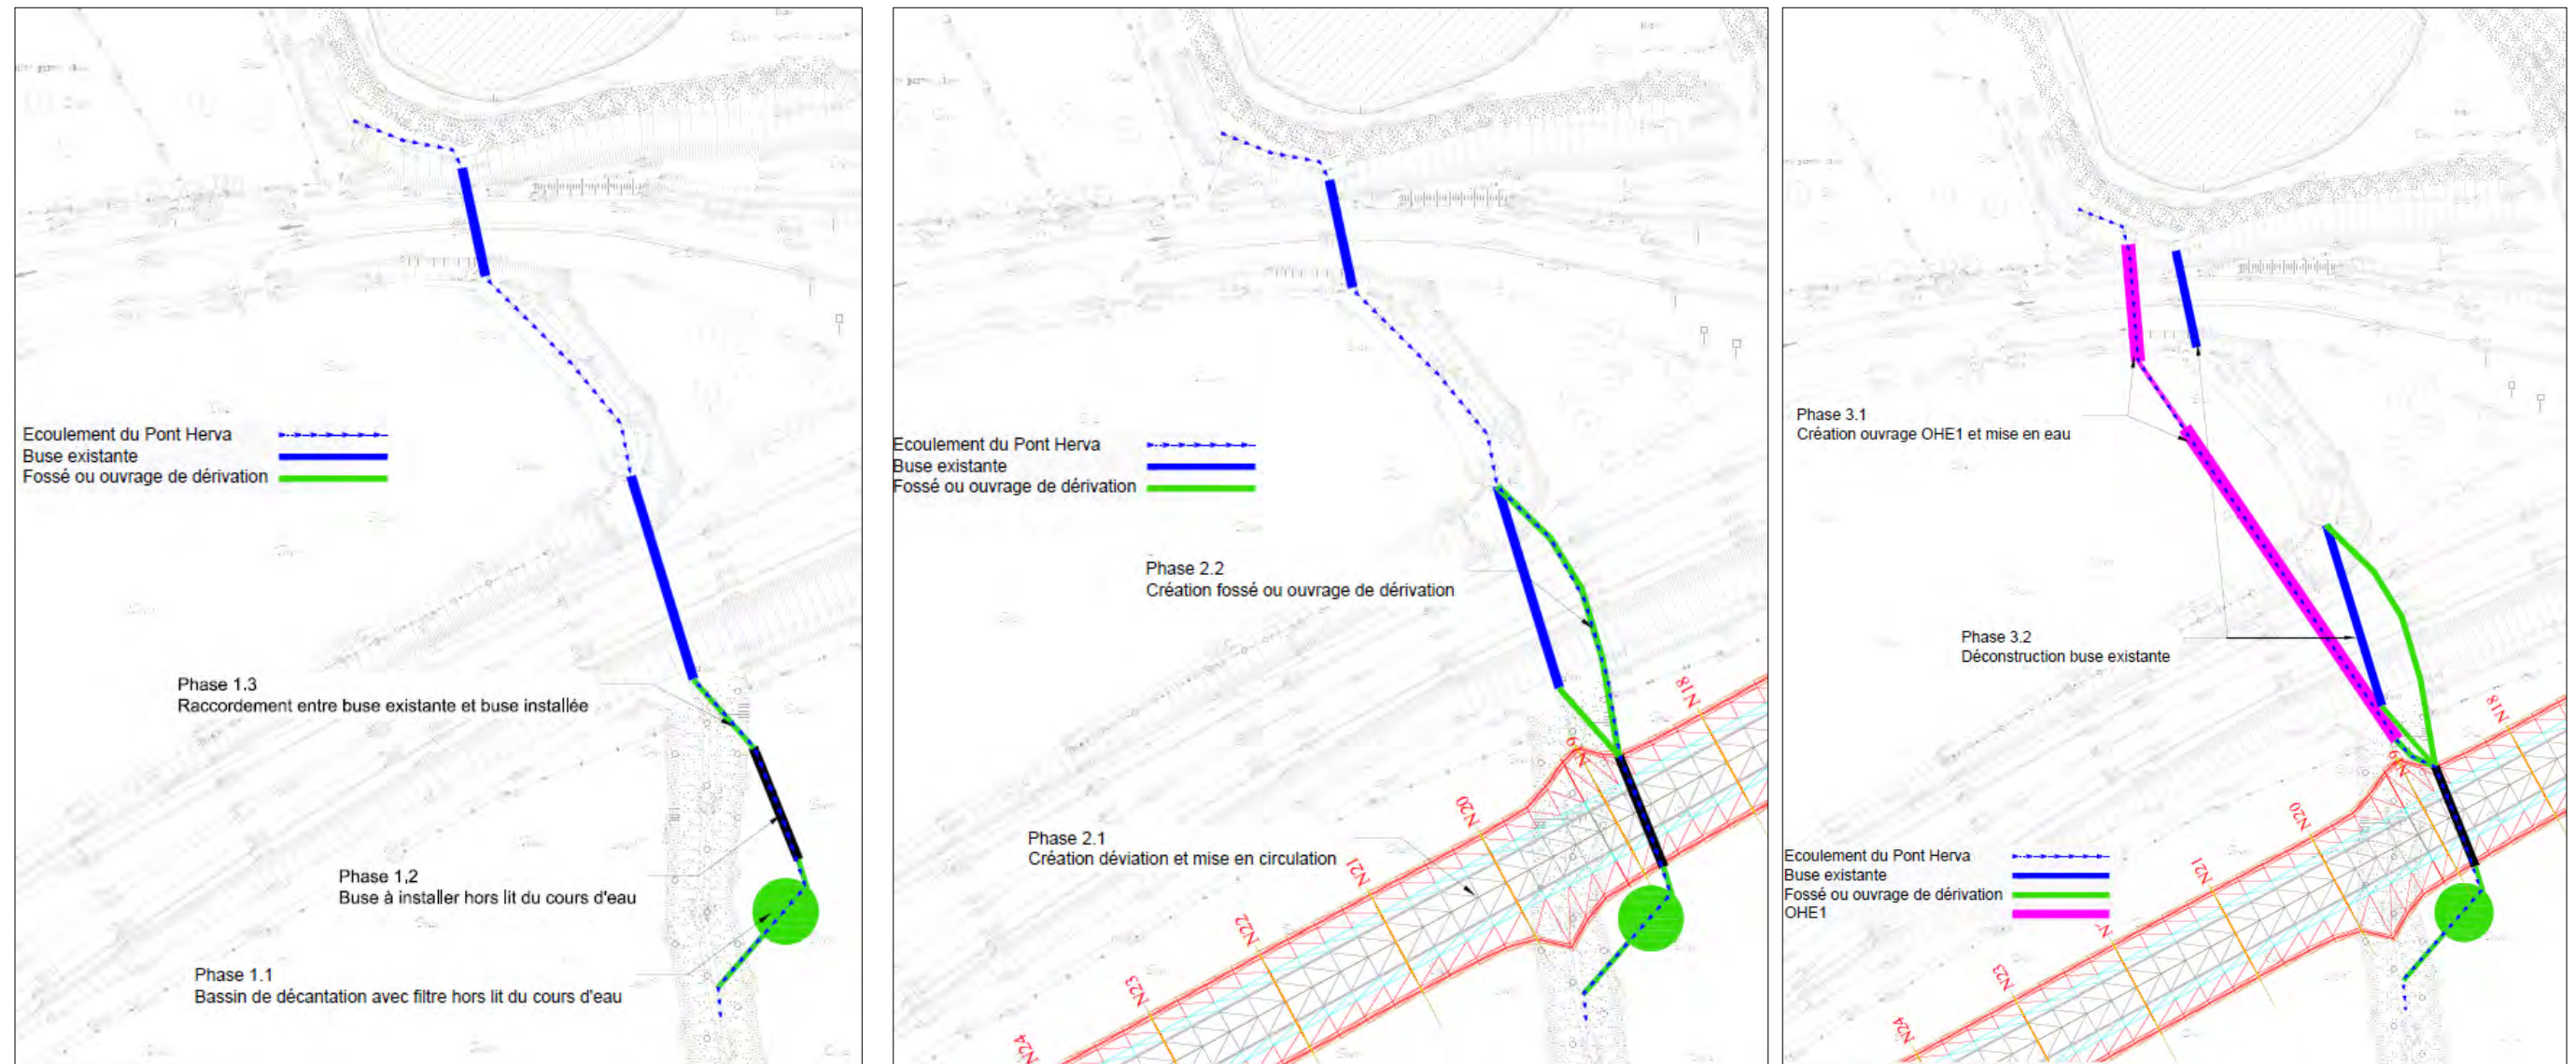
Vue en plan des étapes de construction des ouvrages OHE1 (Source : Egis)
